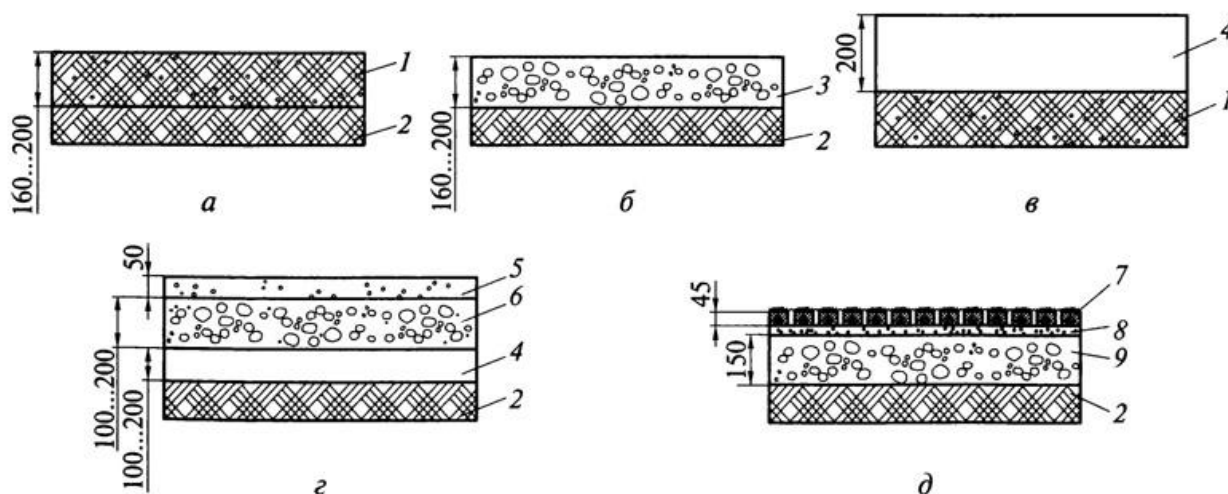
Типовые конструкции мягких покрытий: а – грунтовое; б – щебеночное; в – песчаное; г – из спецсмеси; д – травяное; 1 – м стабилизированный цементом грунт; 2 – подготовленное грунтовое основание; 3 – известняковый щебень с расклиновкой его гранитными высевками; 4 – песок; 5 – спецсмесь; 6 – щебень мелкозернистый известняковый (толщина слоя зависит от типа грунта и нагрузки); 7 – газонная решетка «Соты», смесь растительного грунта с каменными высевками (фракция 2...5 мм); 8 – каменные высевки (фракция 2...5 мм) – толщина слоя 30...40 мм; 9 – щебень твердых пород
